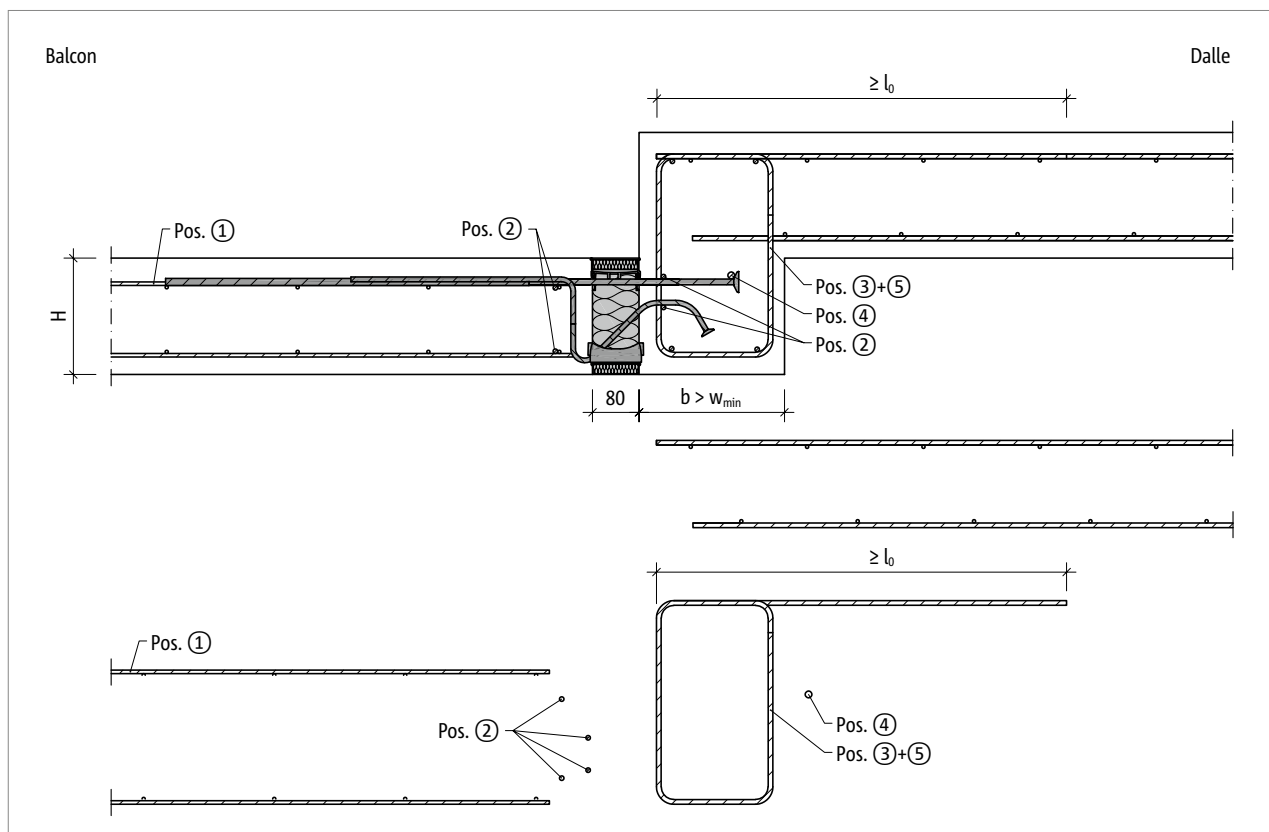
Schöck Isokorb® T type K-U : Renforcement sur site pour balcon avec décalage vers le bas avec une dimension plus grande du composant ($w_{pres} > w_{min}$)
